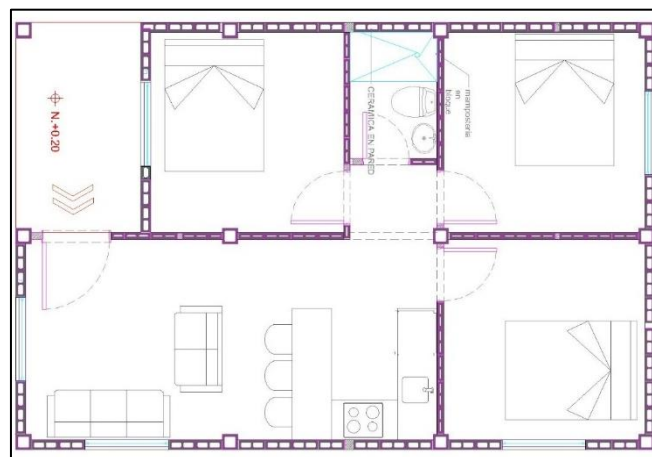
Planta arquitectónica vivienda en hormigón armado Fuente: (MIDUVI, 2023)
